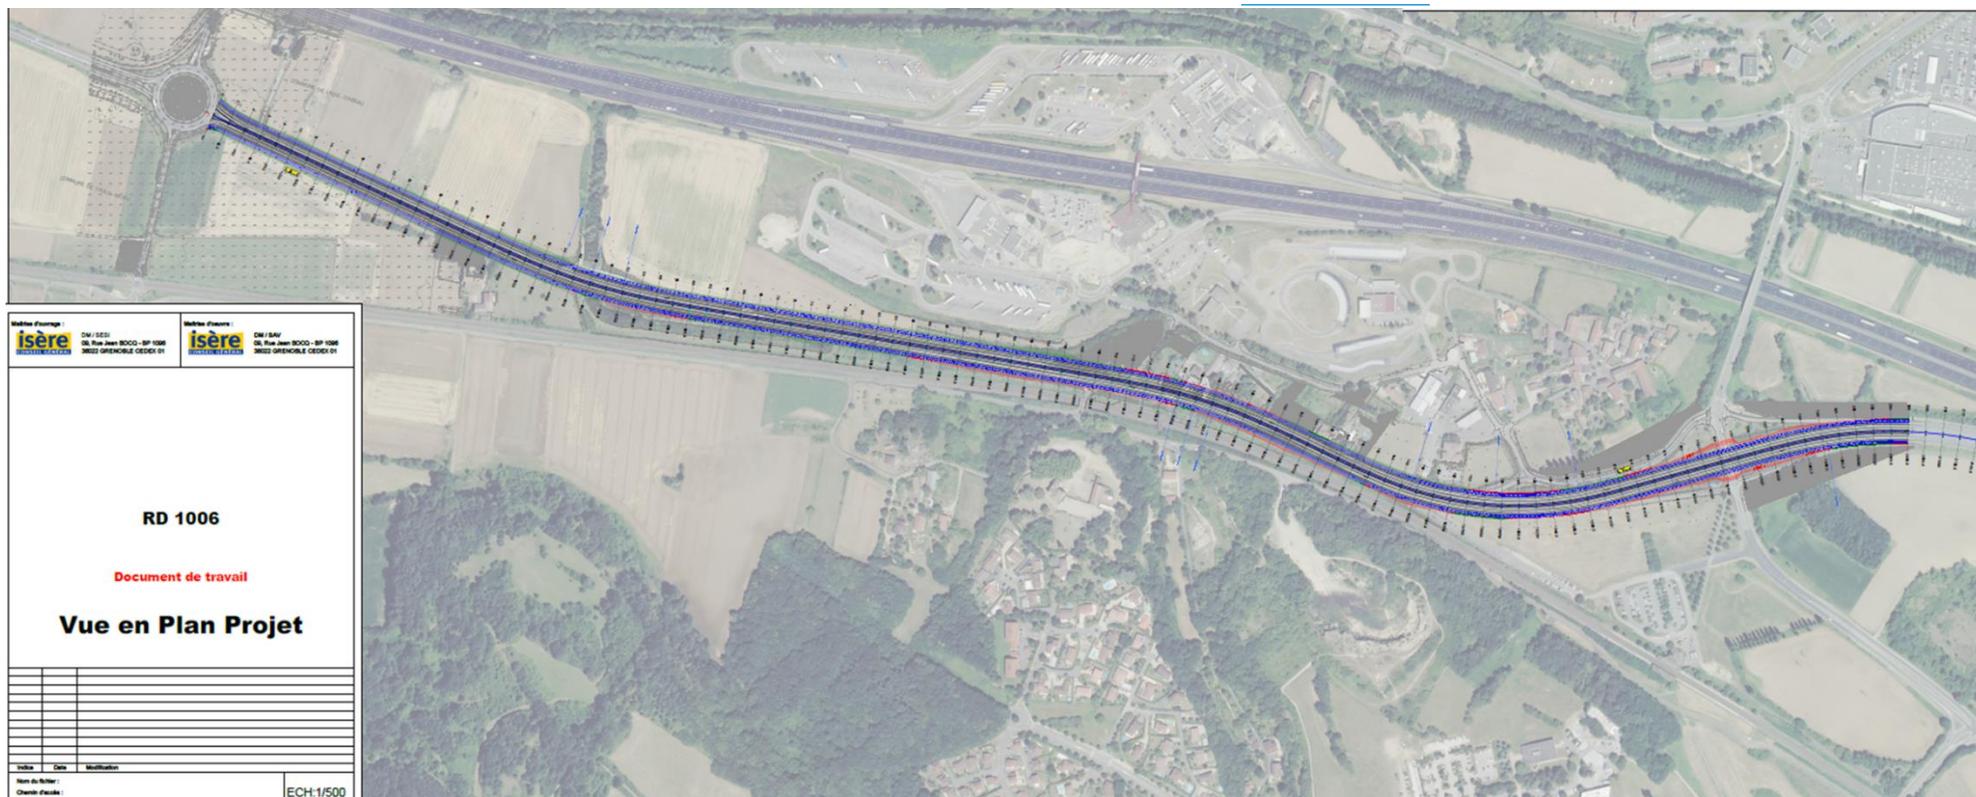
Plan masse du projet (Source : CD38, 2023)
